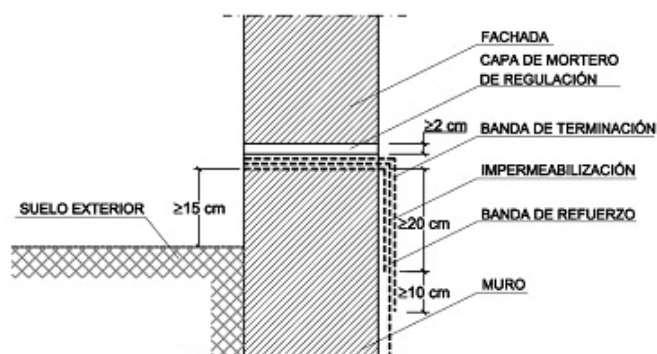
Ejemplo de encuentro de un muro impermeabilizado por el interior con lámina con una fachada
